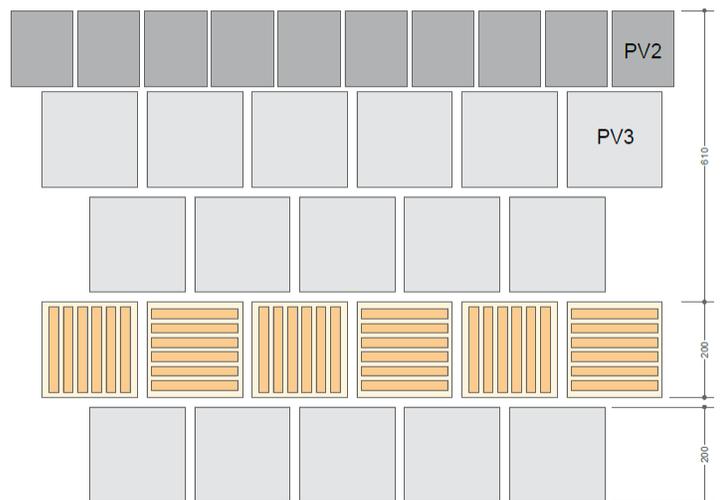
Pavimento para zonas comunes/Plazoletas PV5
